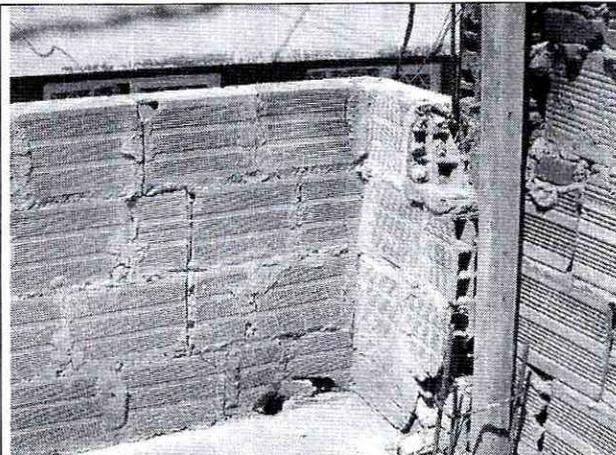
Vivienda emplazada en el predio de la Carrera 5B Bis A No. 56-42 Sur.
